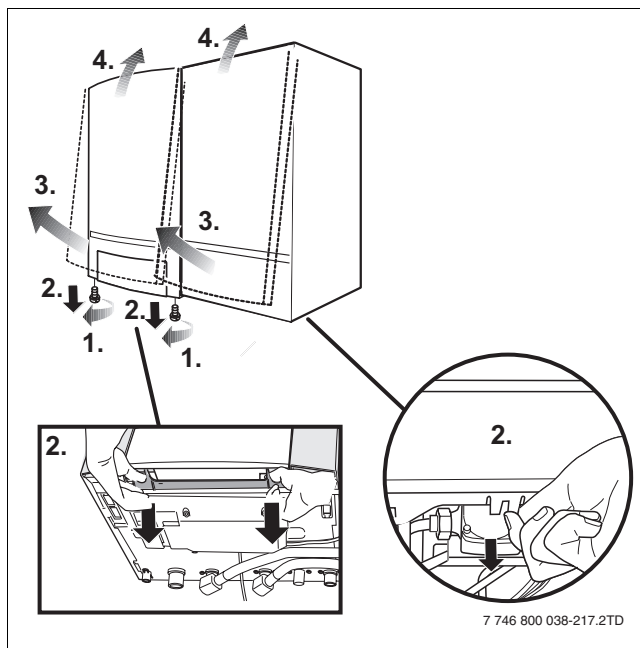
Демонтаж облицовки бака-водонагревателя с послойной загрузкой
